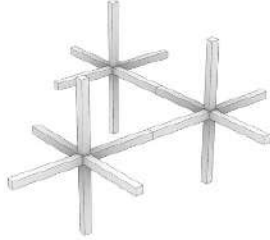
Prove di assemblaggio e analisi strutturale - Integrazione tra Karamba 3D e Assembler con elementi beam
